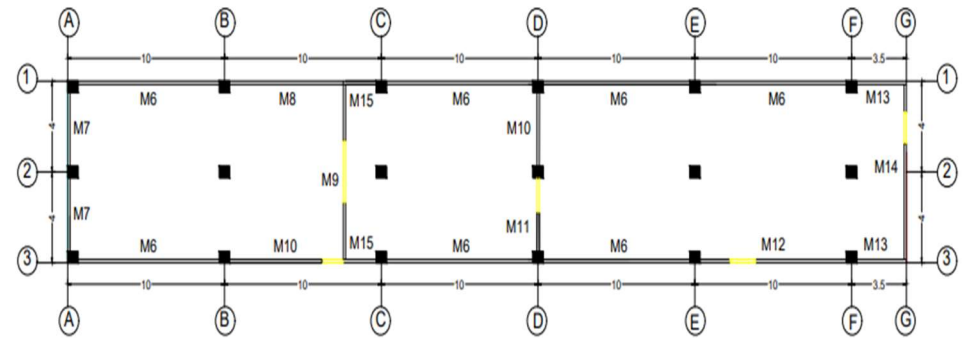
Ubicación de los tipos de muros. 2023 imagen: Lucero Gómez
